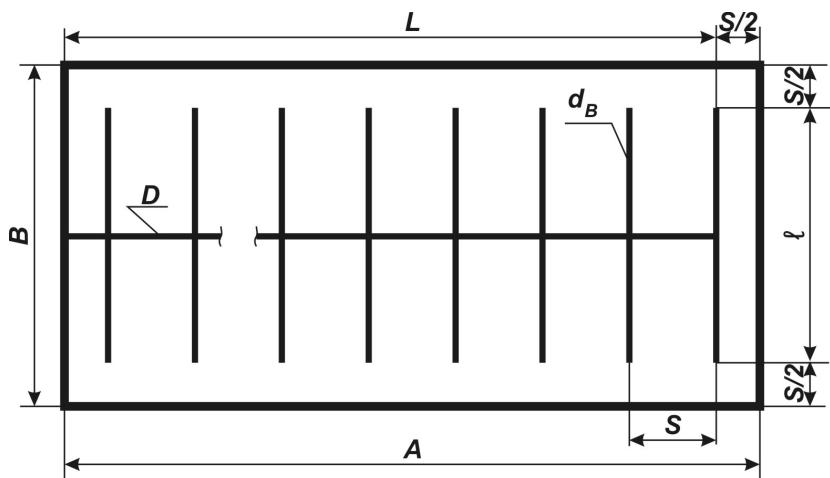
Схема размещения трубопроводов в защищаемом помещении
